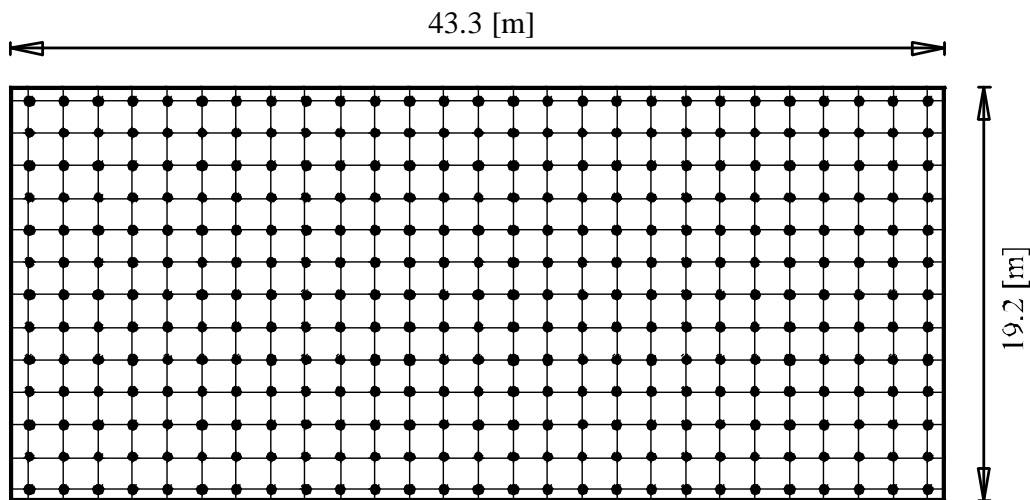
Stonebridge Tower: FE-Netz der Platte mit Pfählen
